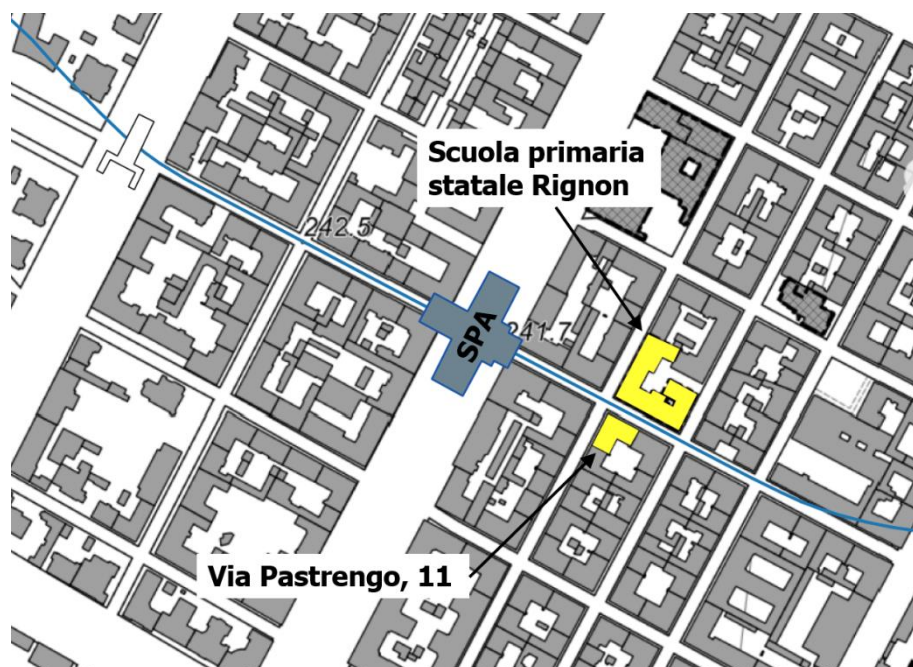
Ubicazione planimetrica dei ricettori selezionati nelle vicinanze della stazione di collegamento impianti di Pastrengo (SPA).
